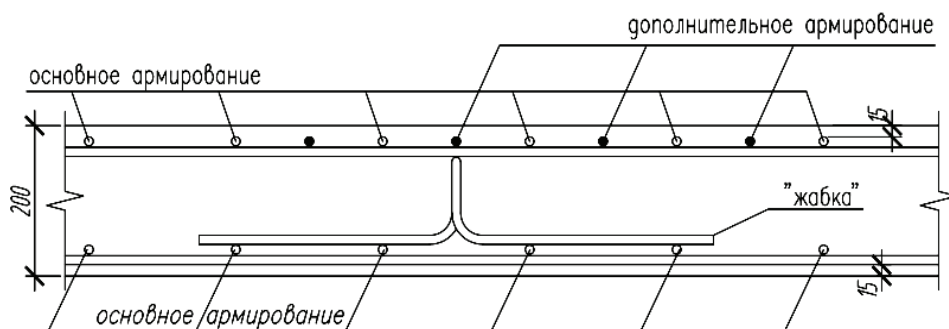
Характерное поперечное сечение монолитной безбалочной плиты перекрытия.
